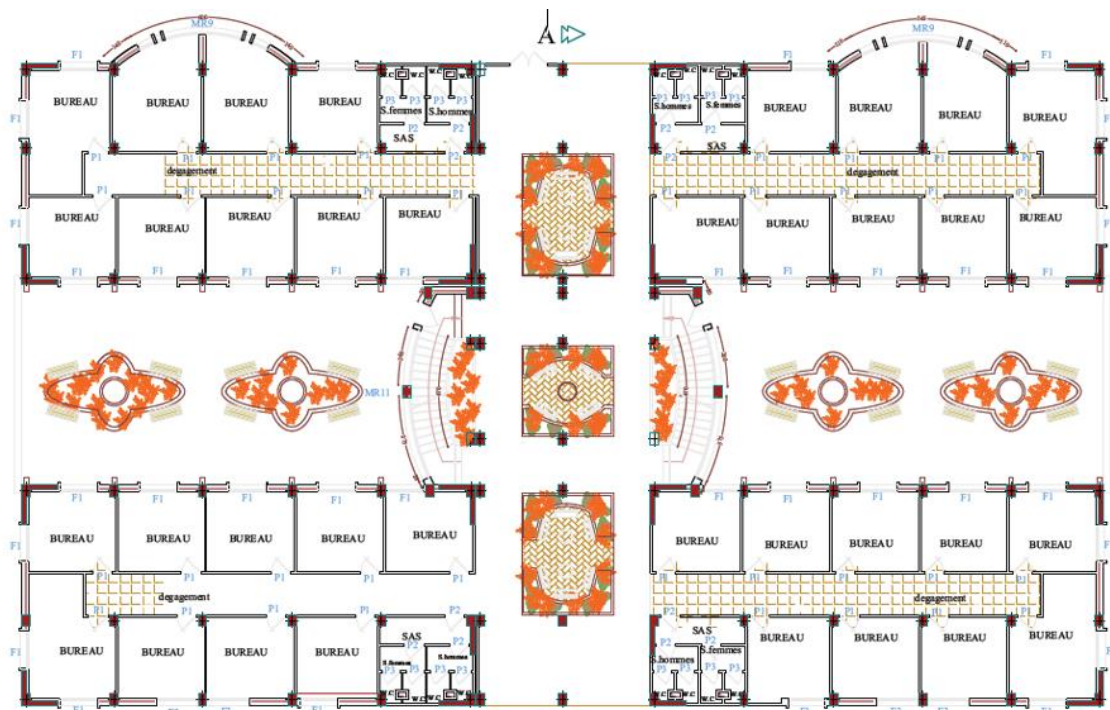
Plan RDC de l'immeuble (source : BET SEFACENE).
